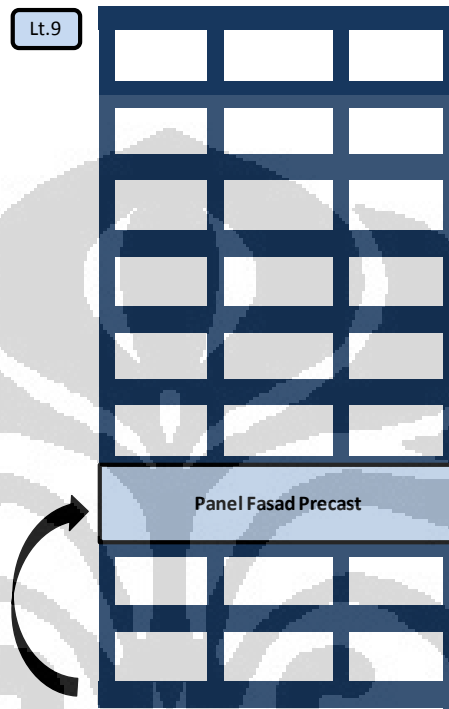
Zona Pekerjaan Instalasi Panel Facade
